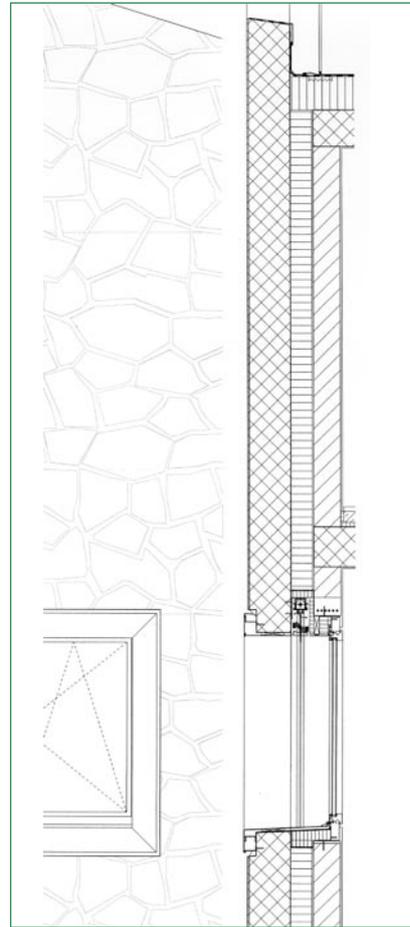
Zweischalige Stahlbetonwand mit innenliegender Wärme-dämmung
